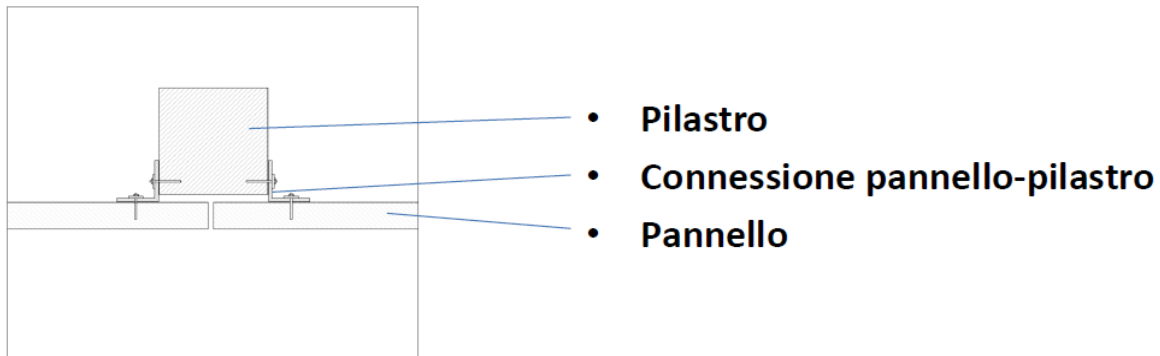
Angolari in acciaio bullonati a pilastri e pannello ai due spigoli inferiori
